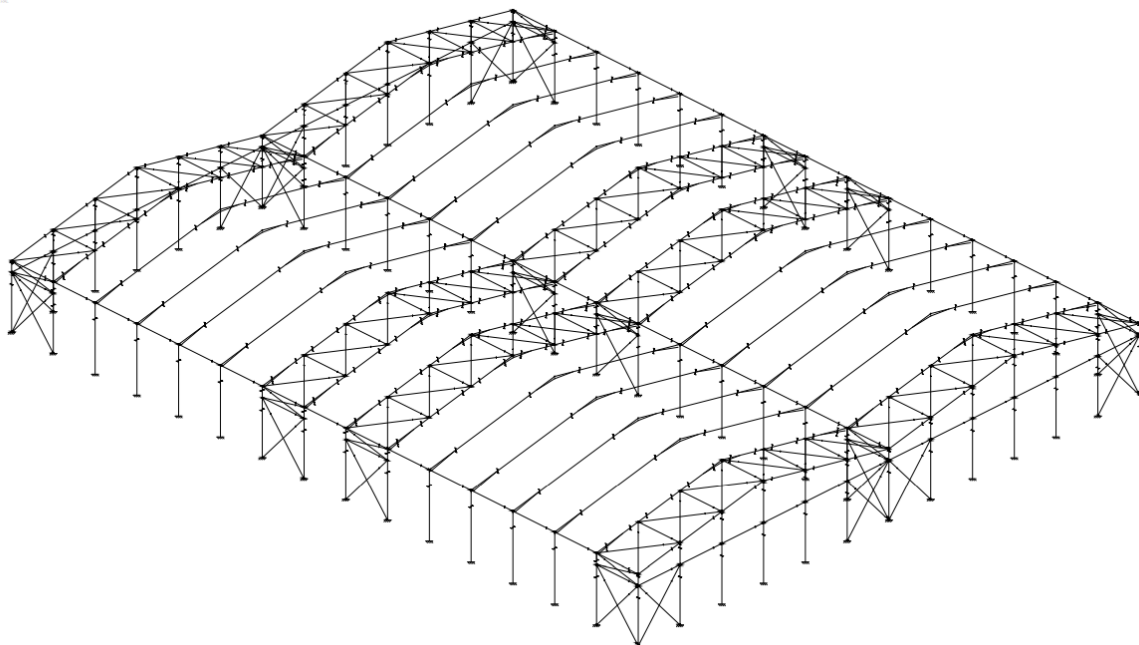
Estructura metálica de la nave (CYPE 3D).
